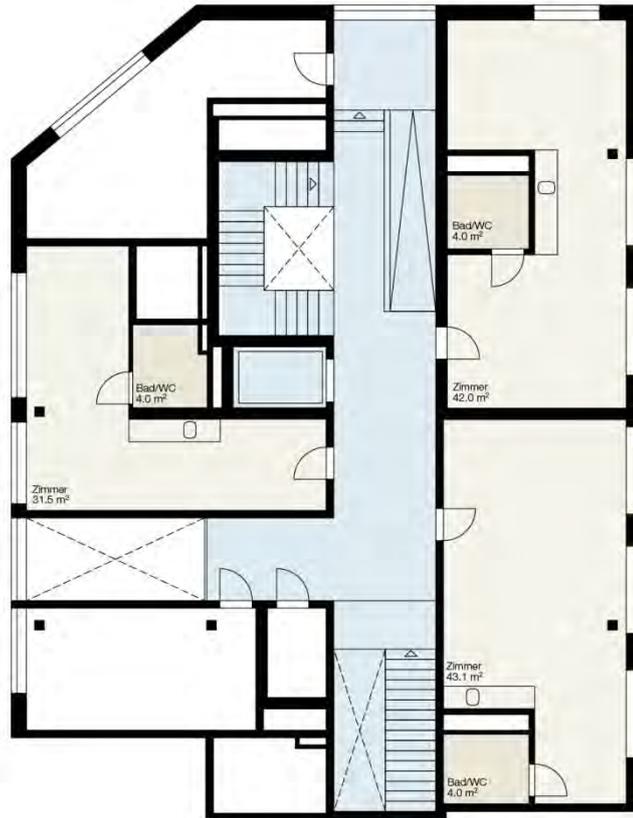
Grundriss der Clusterwohnung im 5. Obergeschoss
